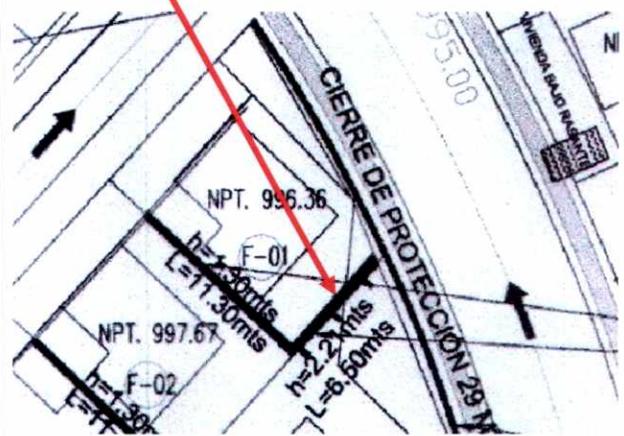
Altura viga dentada entre sitios D-01/D-02 e imagen de altura viga proyectada en "Detalle A" de la lámina N° 5 "Cierres de Protección", del proyecto modificado.
